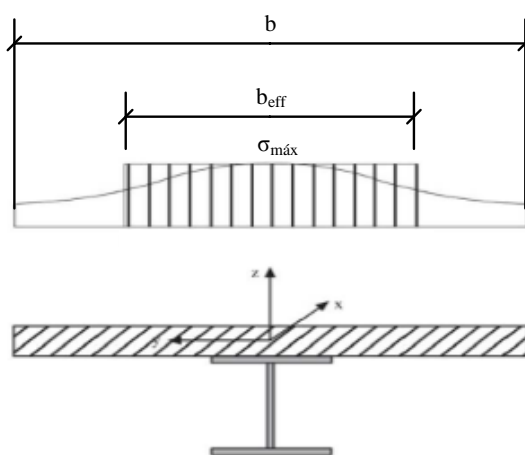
Distribuição das tensões de corte longitudinais na laje de betão em vigas mistas (adaptado de Pais Martins Pinto (2009)).
